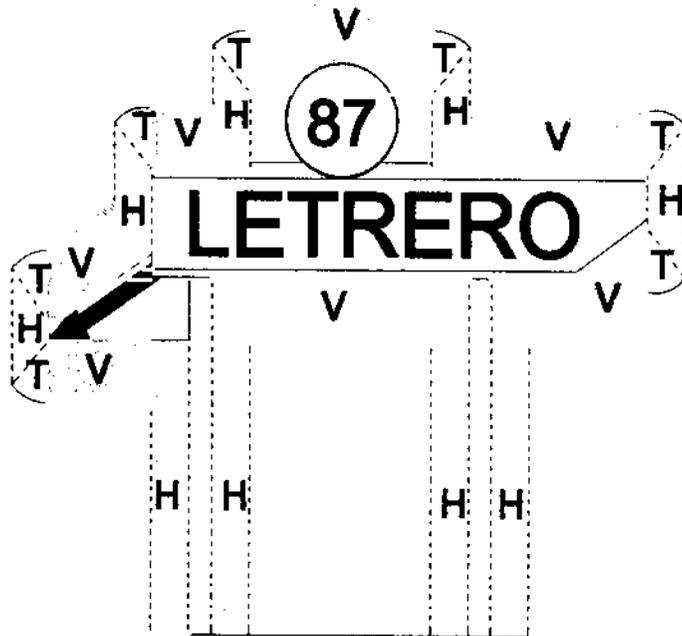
FIG. (B) SEPARACION DE OTRAS ESTRUCTURAS
